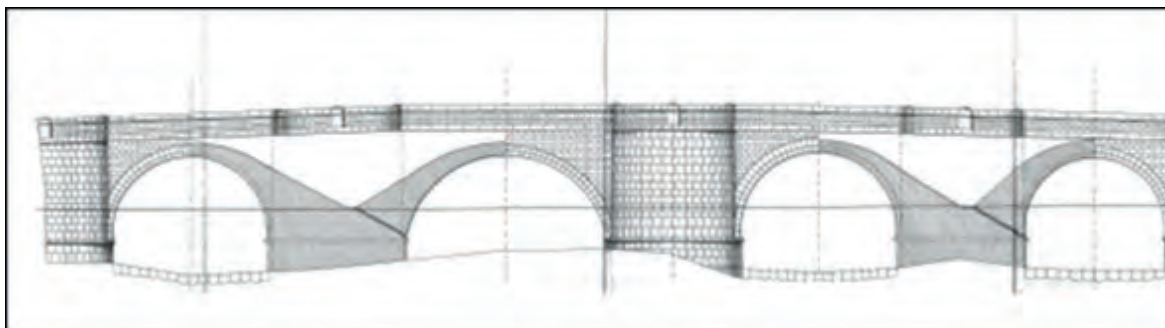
Vanos 5 al 8. Alzado aguas abajo / sección longitudinal.
